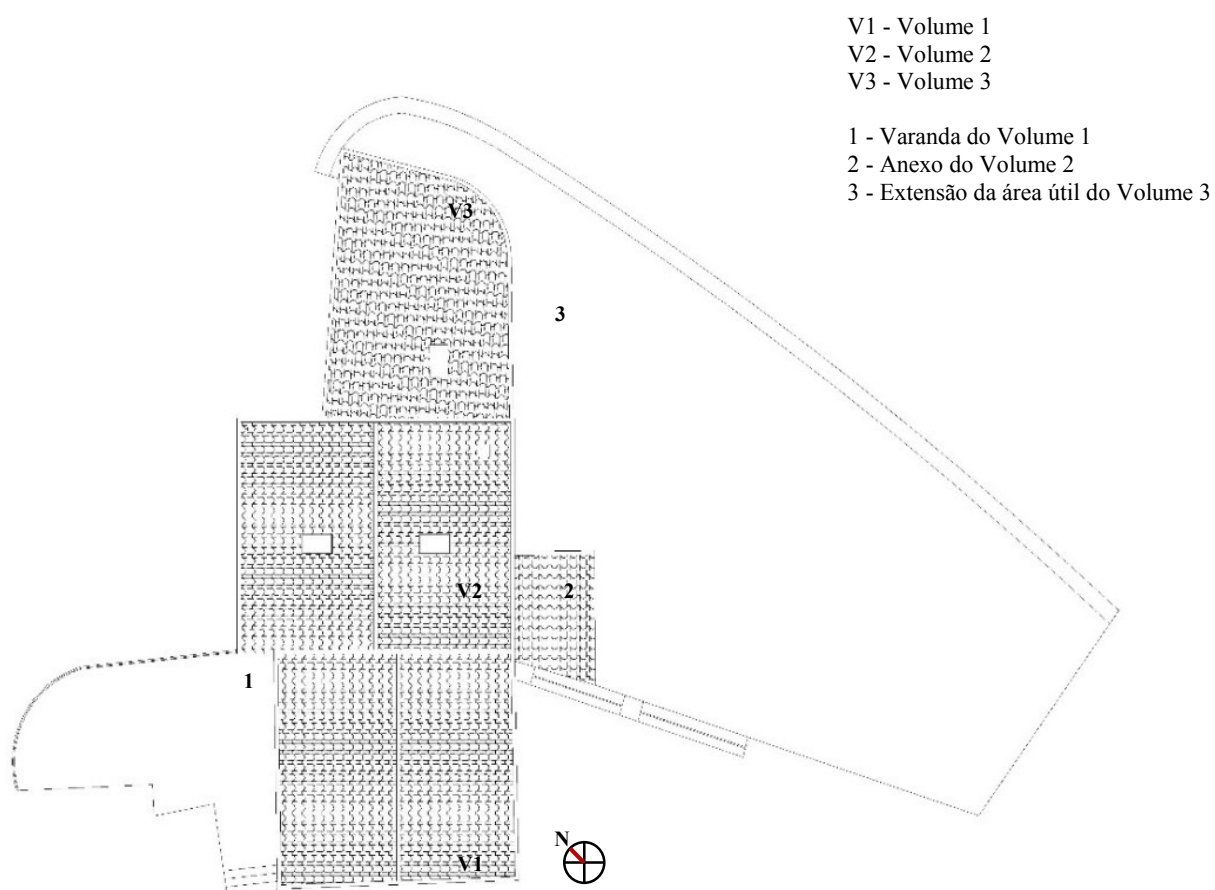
Planta de cobertura do edifício a intervir – Casa da Eira; Fonte: Autor
